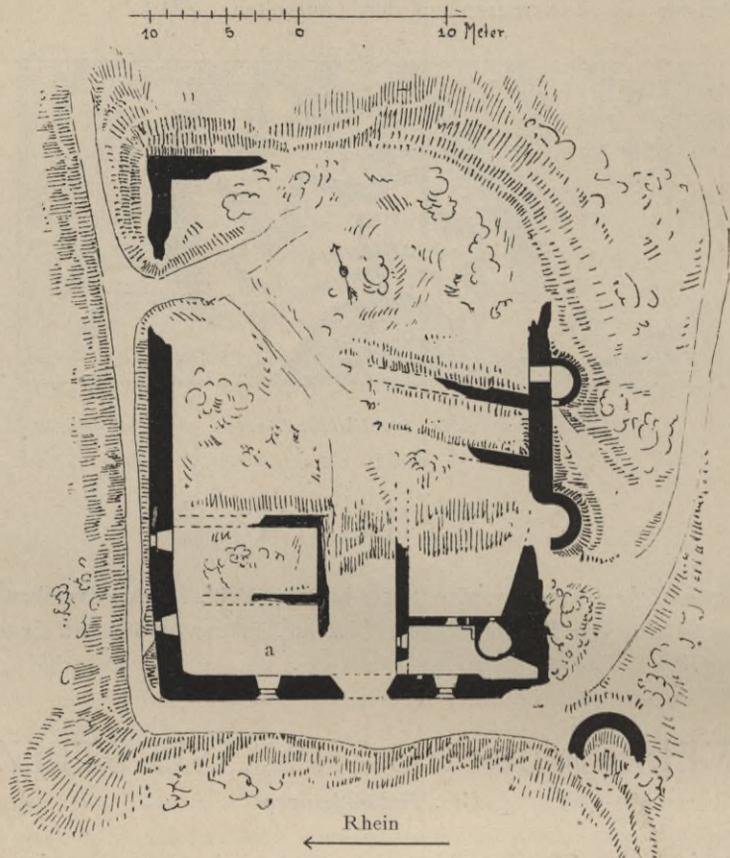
Weisswasserstelz. Grundriss der Burg. I.
